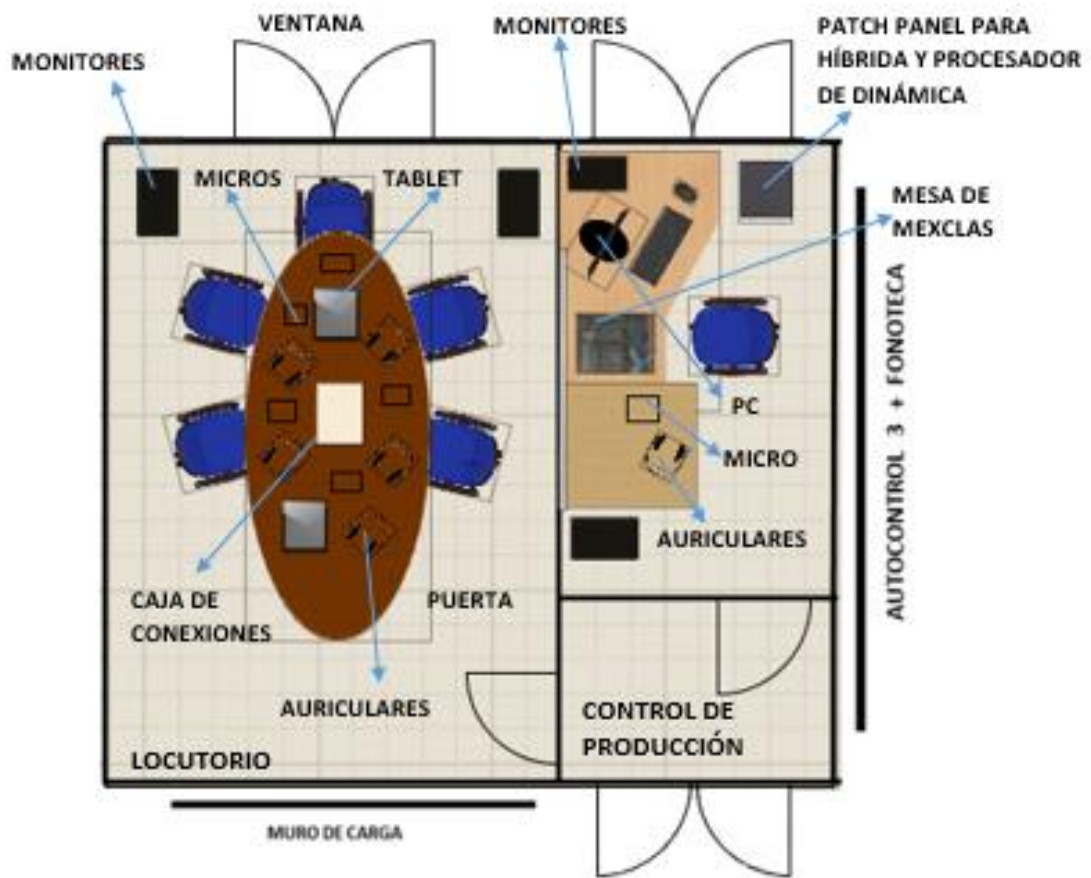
Estancias ocupadas de la planta baja (después)
